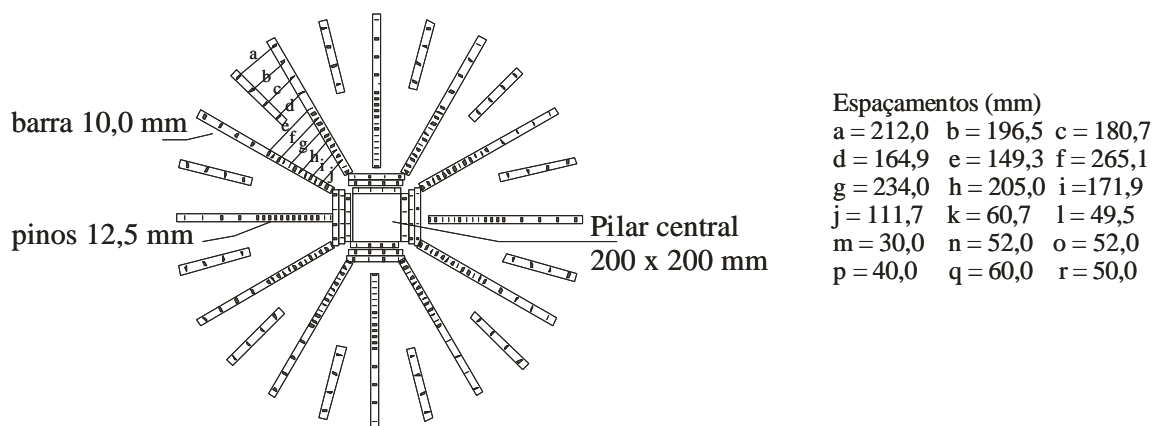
Distribuição da armadura de cisalhamento da laje E2, de Trautwein (2006)
